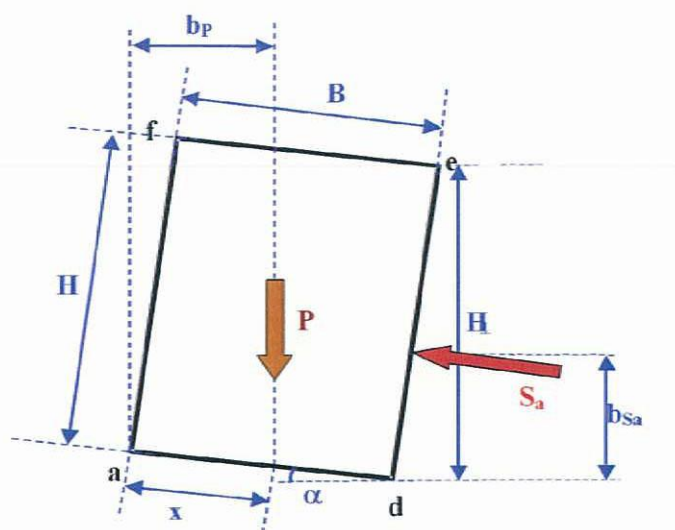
Schema statico di una palificata inclinata rispetto all'orizzontale (sezione).
